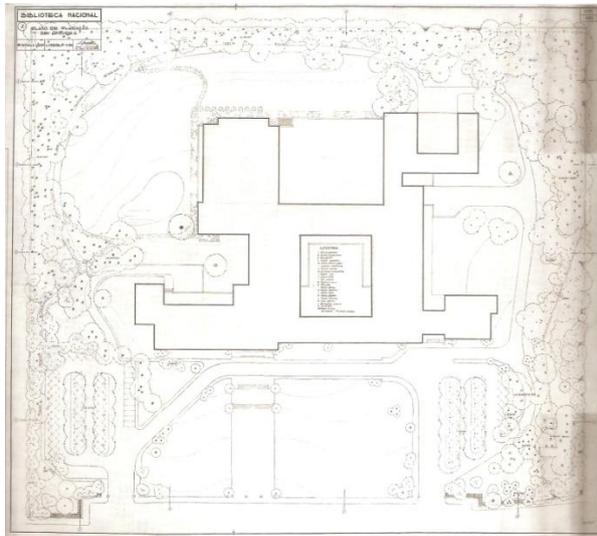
Biblioteca Nacional: Plano de plantação de árvores. 1956.
